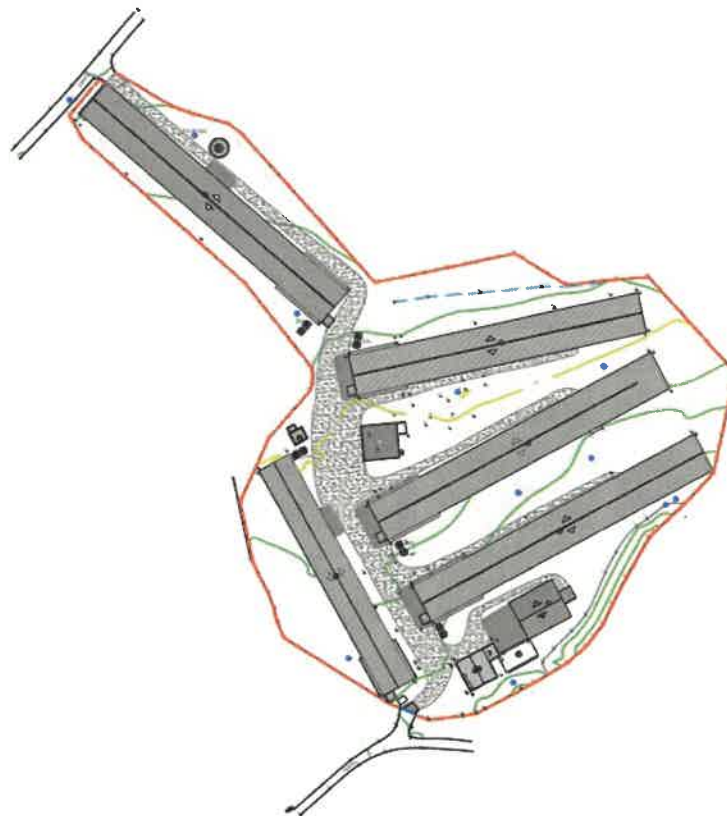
Extrato da Planta de Implantação (Fonte: Anexo 5 do EIA)
